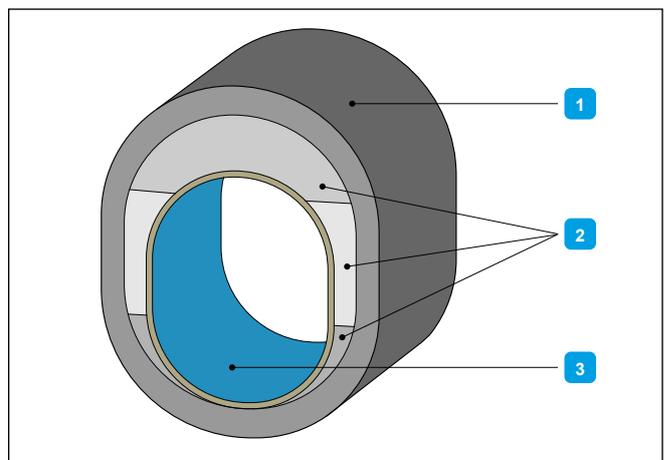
Aplicação da argamassa fina por etapas | Legenda: 1 - Tubo existente; 2 - Fases de aplicação da argamassa fina; 3 - Perfil Amiblu-Tubagens não circulares
